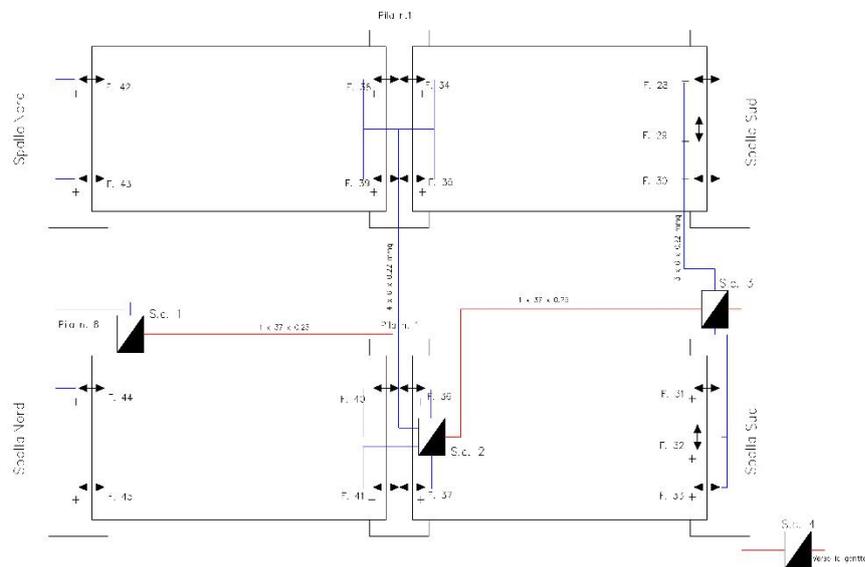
Viadotto Cacchione - Schema dei trasduttori di movimento relativo pila/spalle-impalcati
